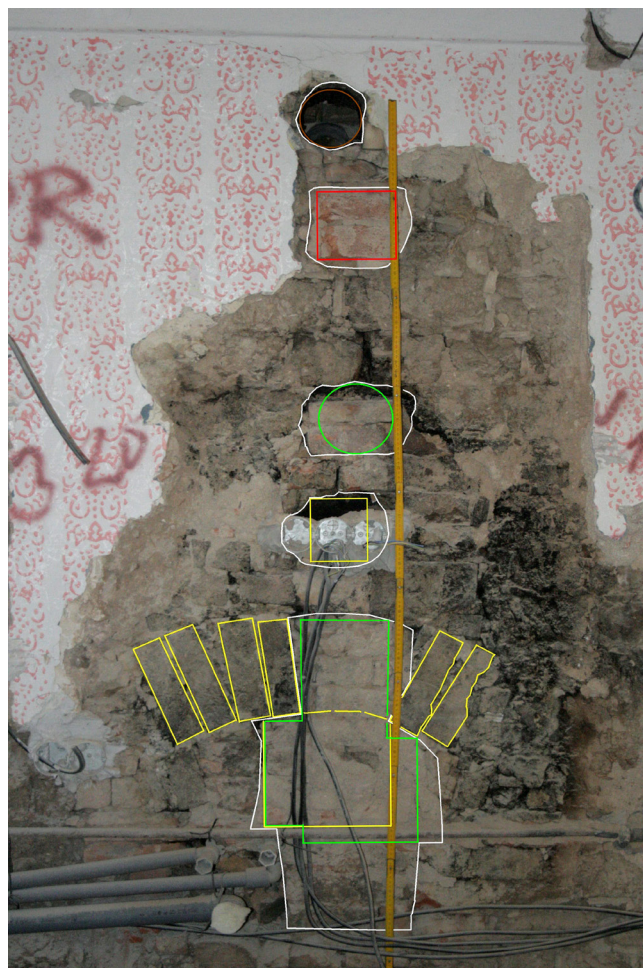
Detail západní stěny černé kuchyně s druhotně zahloubenou odkládací nikou. Foto: Kamil Podroužek.
